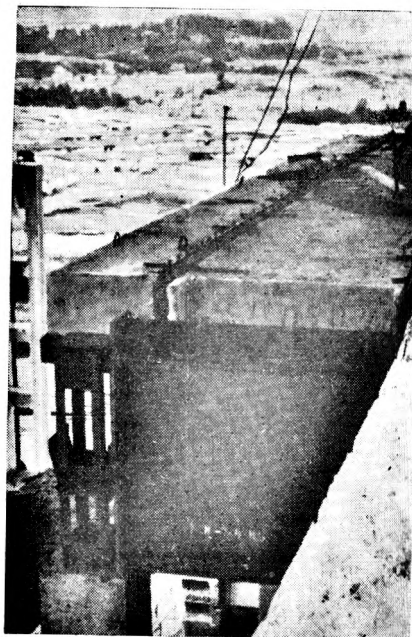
Производство работ по устройству сборно-монолитного настила перекрытия
